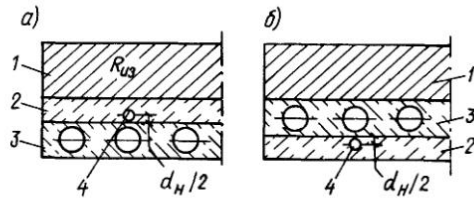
Расчетные схемы размещения нагревательных элементов поверх перекрытия (а) и под перекрытием (б)
